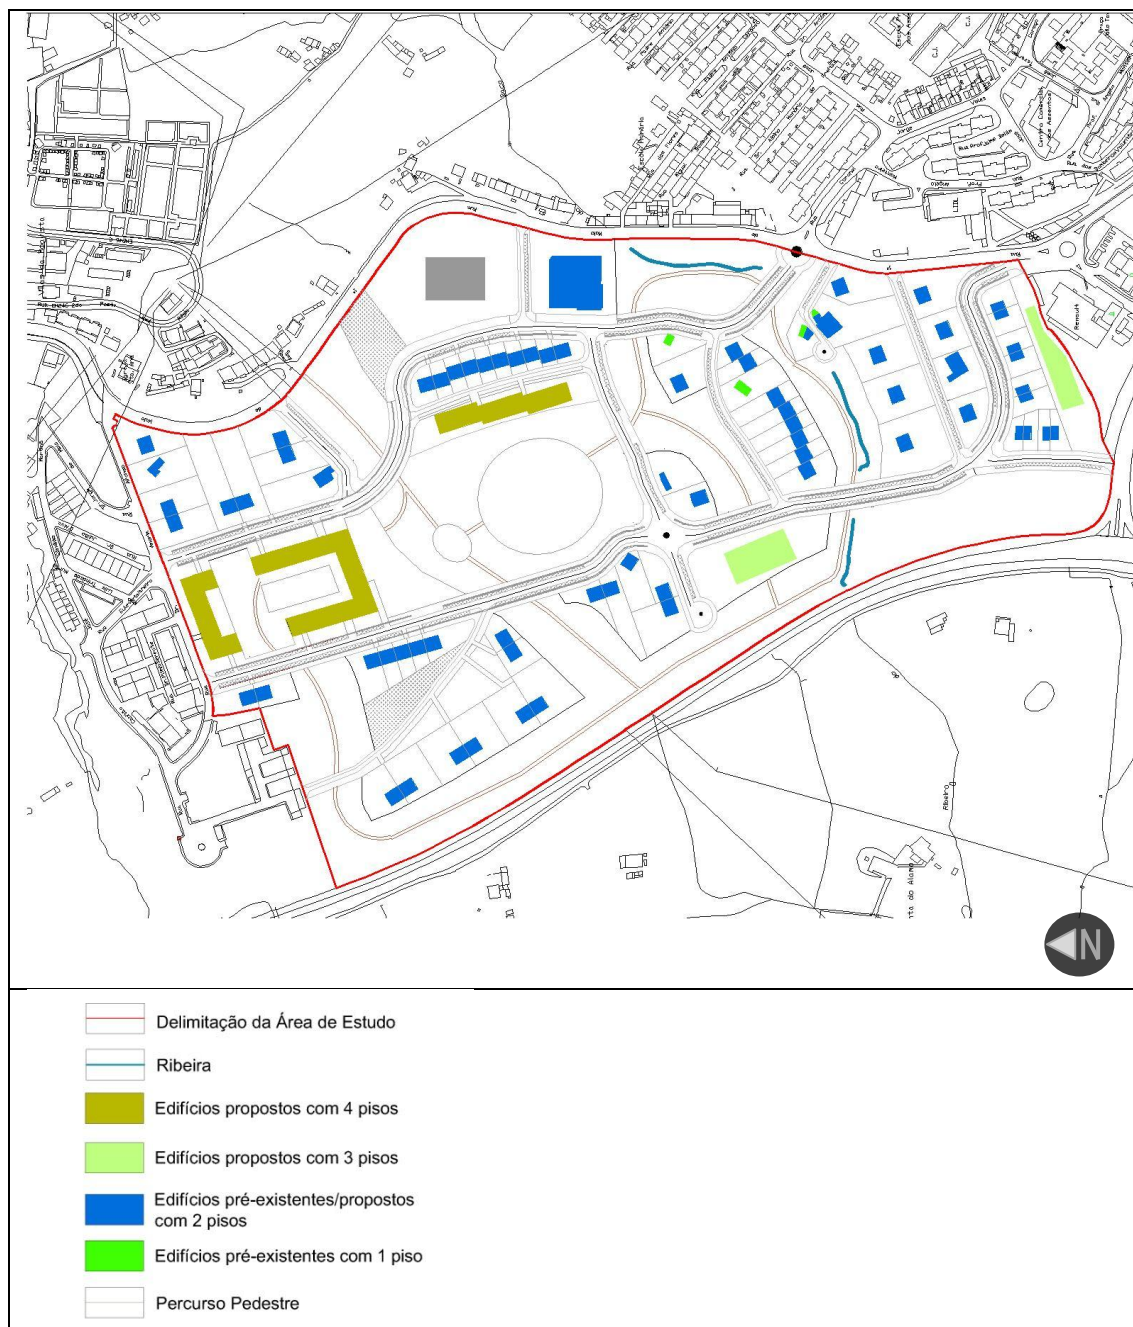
Número de pisos do edificado proposto (FONTE: *autor*), [PLANTA B/22]; (Escala: gráfica)
